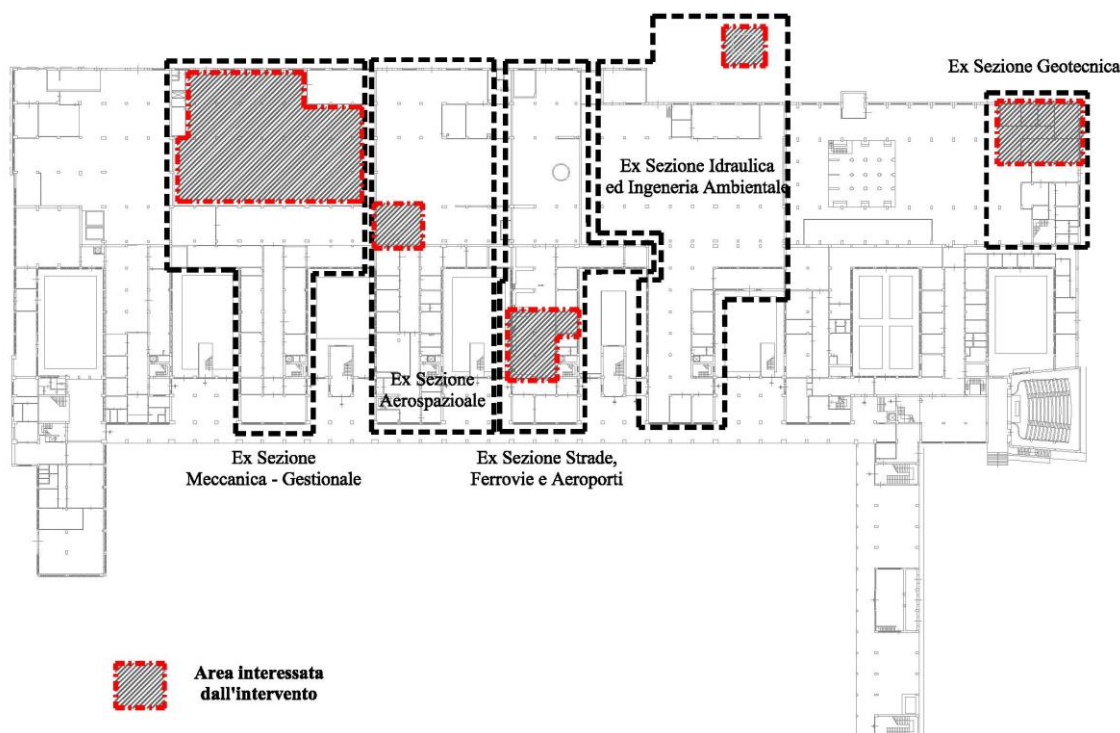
Edificio 8 a Parco D'Orleans – Ingegneria – Planimetria di Piano terra – Aree di intervento.
